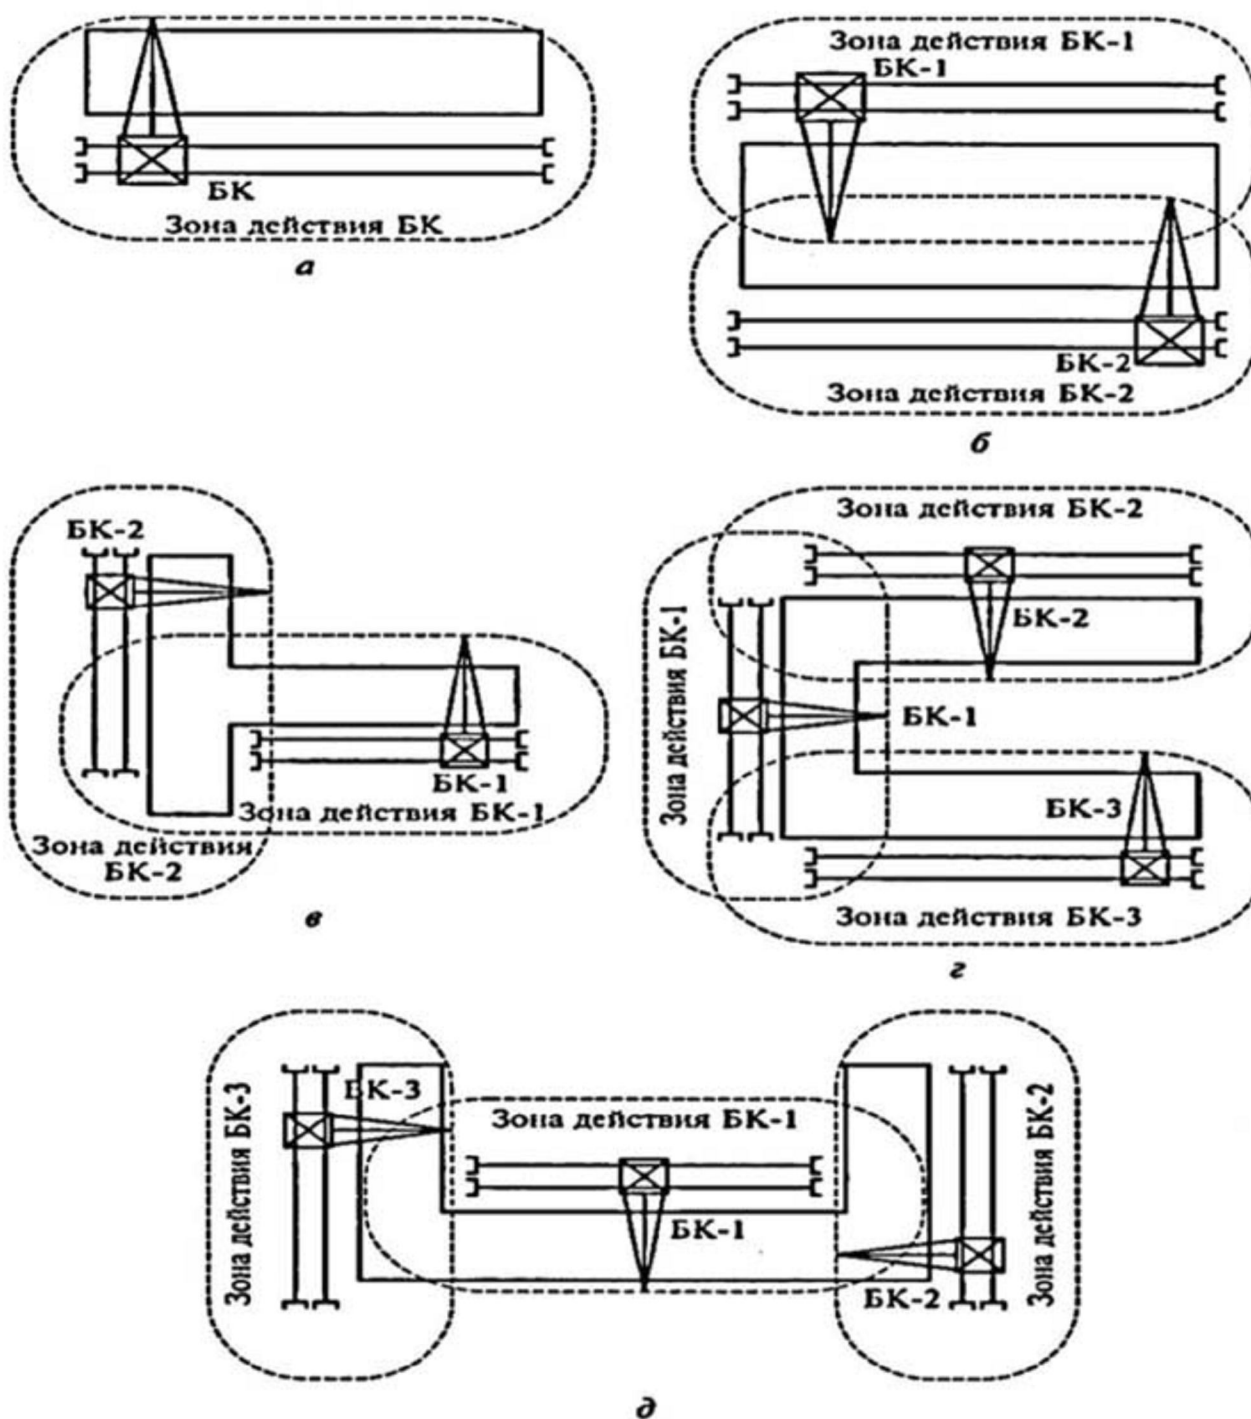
Схема расположения башенных кранов относительно возводимых зданий: БК-1, БК-2, БК-3 – соответственно башенный кран 1, 2, 3
